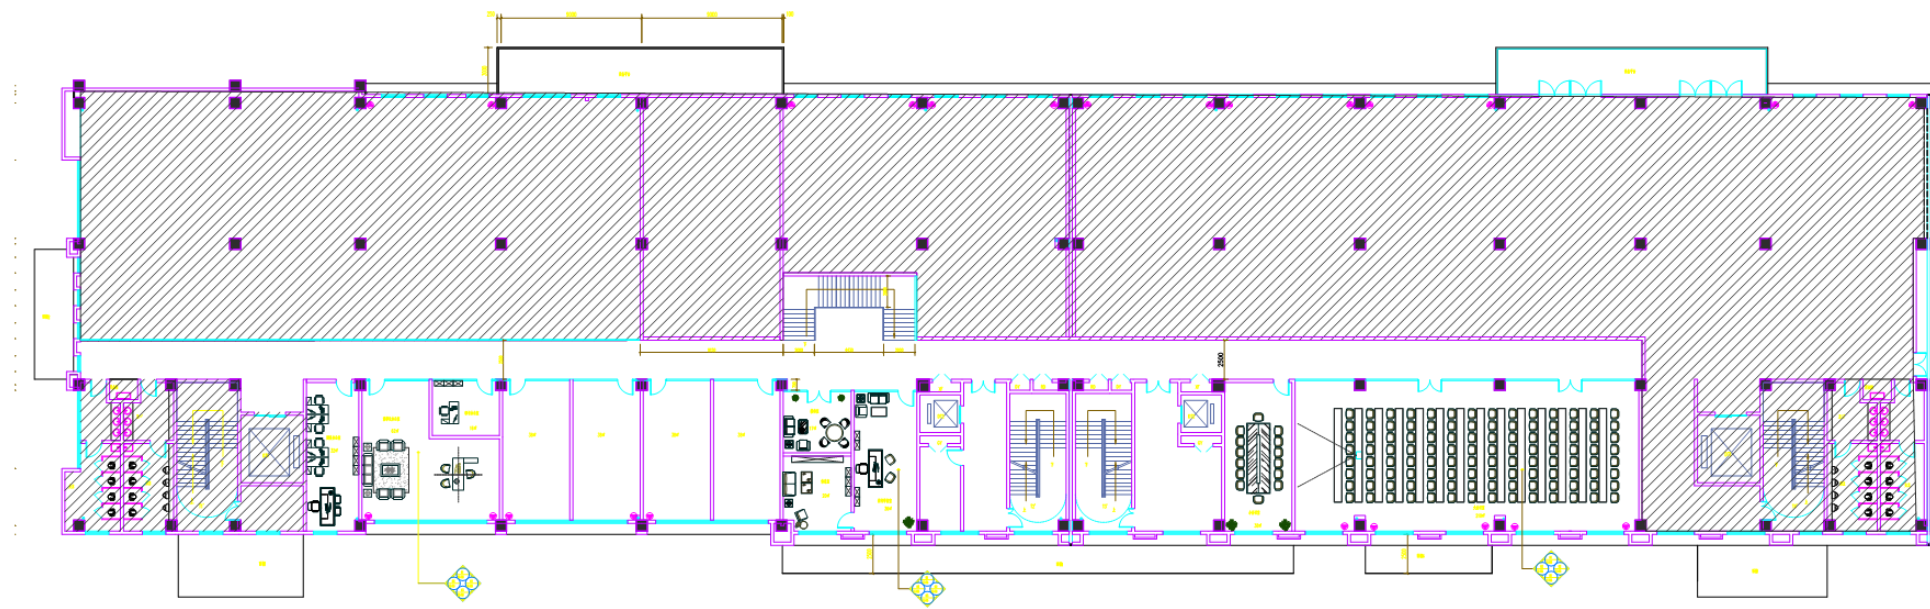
(2) 厂区二楼夹层总平面布置图
